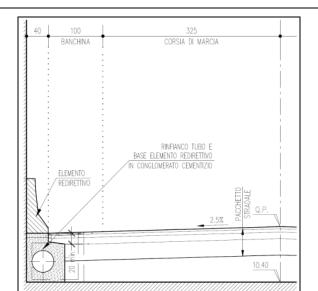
PARTICOLARE POSIZIONAMENTO CANALETTA
